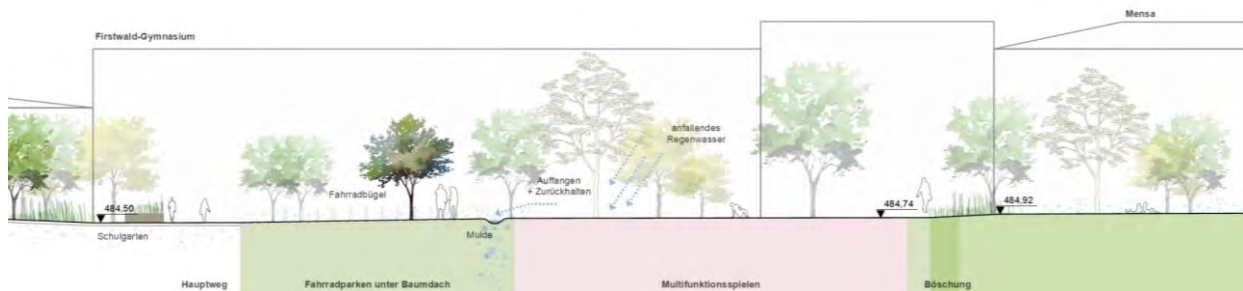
Planausschnitt Vorentwurf Grüne Spiel- und Sportflächen Ffirstwaldgymnasium (Anhang Plan 1.1), Schnitt (Anhang Plan 1.2) (faktorgrün, 2025)
